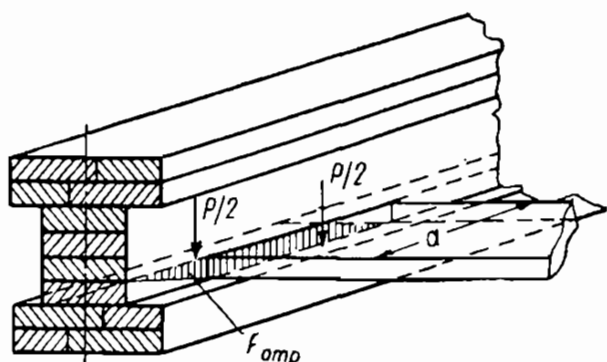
Расчетная схема на отрыв нижней полки от стенки
